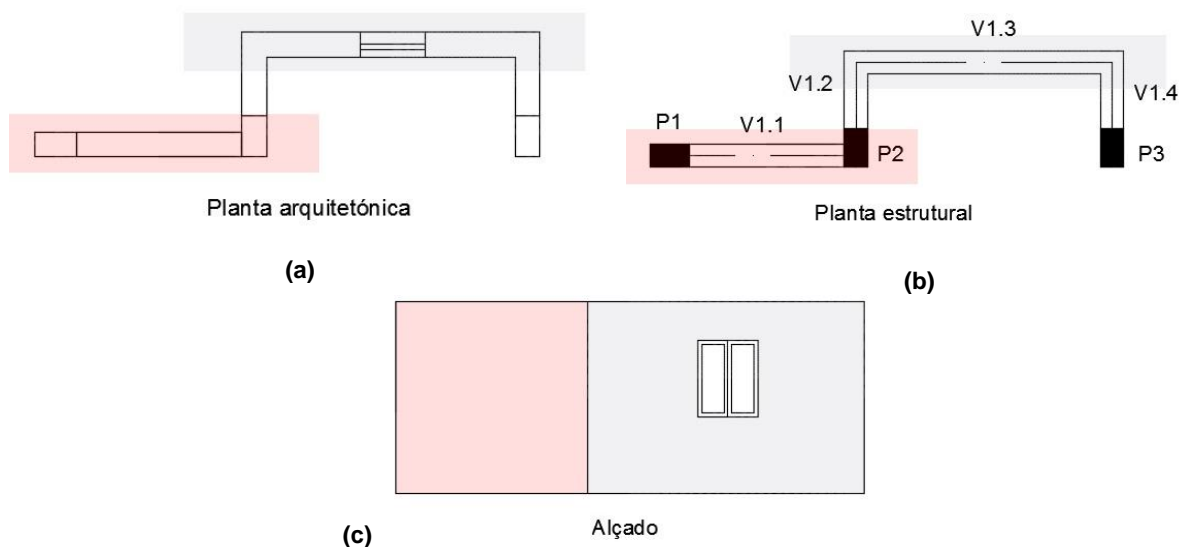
Identificação de paredes confinadas e não confinadas: (a) Planta arquitetónica; (b) Planta estrutural; (c) Alçado.
